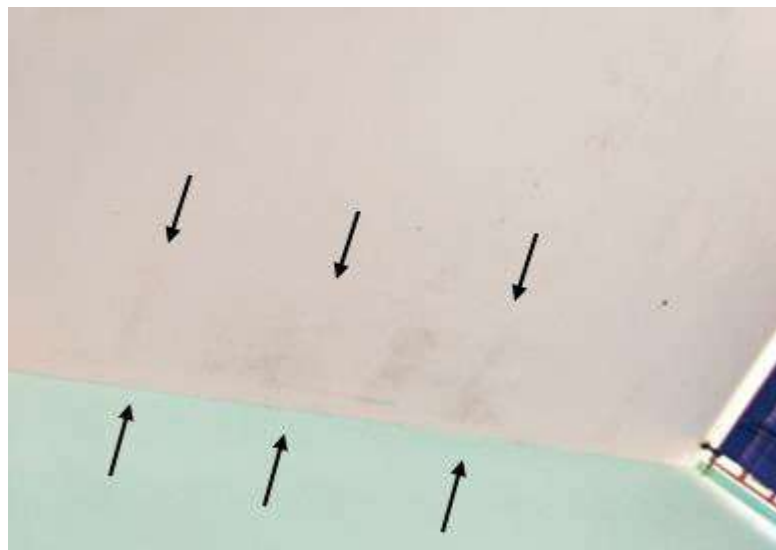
Umidade de infiltração na laje: decorrente da falha dos beirais.
